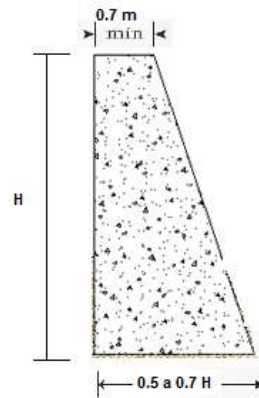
2 Dimensiones de Muro en Base a Factibilidad Constructiva.
